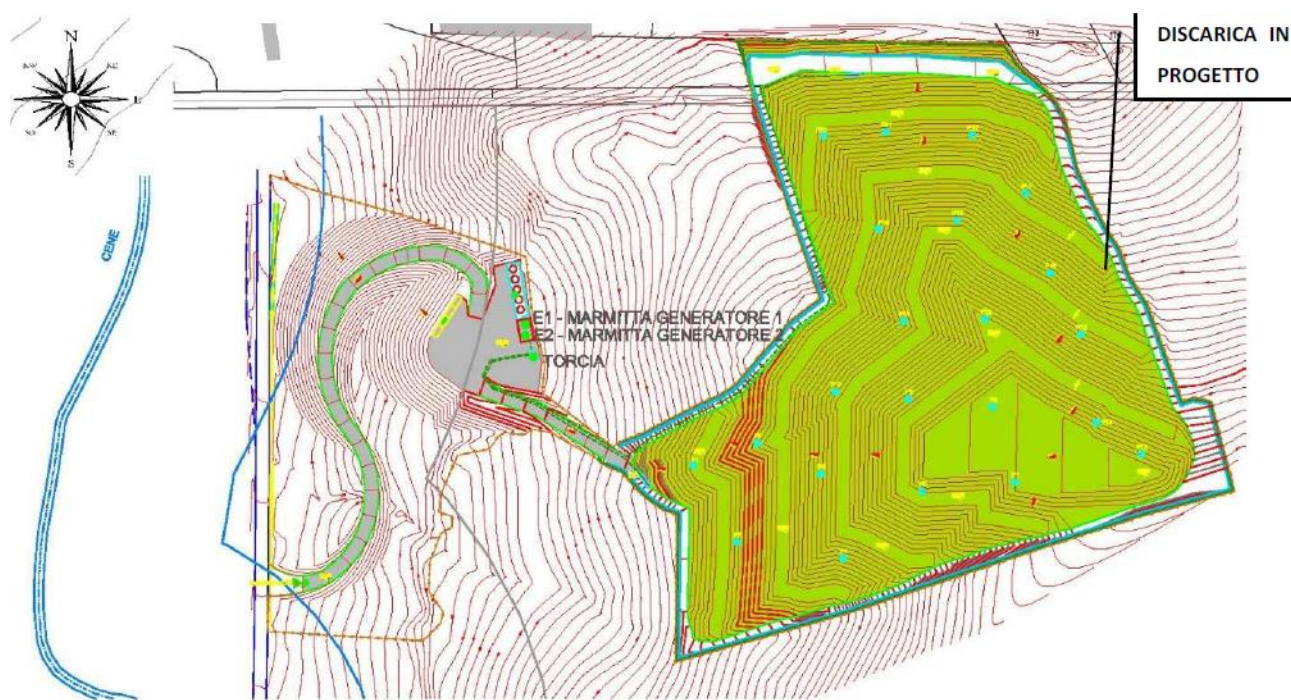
Planimetria dello stato di progetto – nuova discarica ed impianti di servizio
